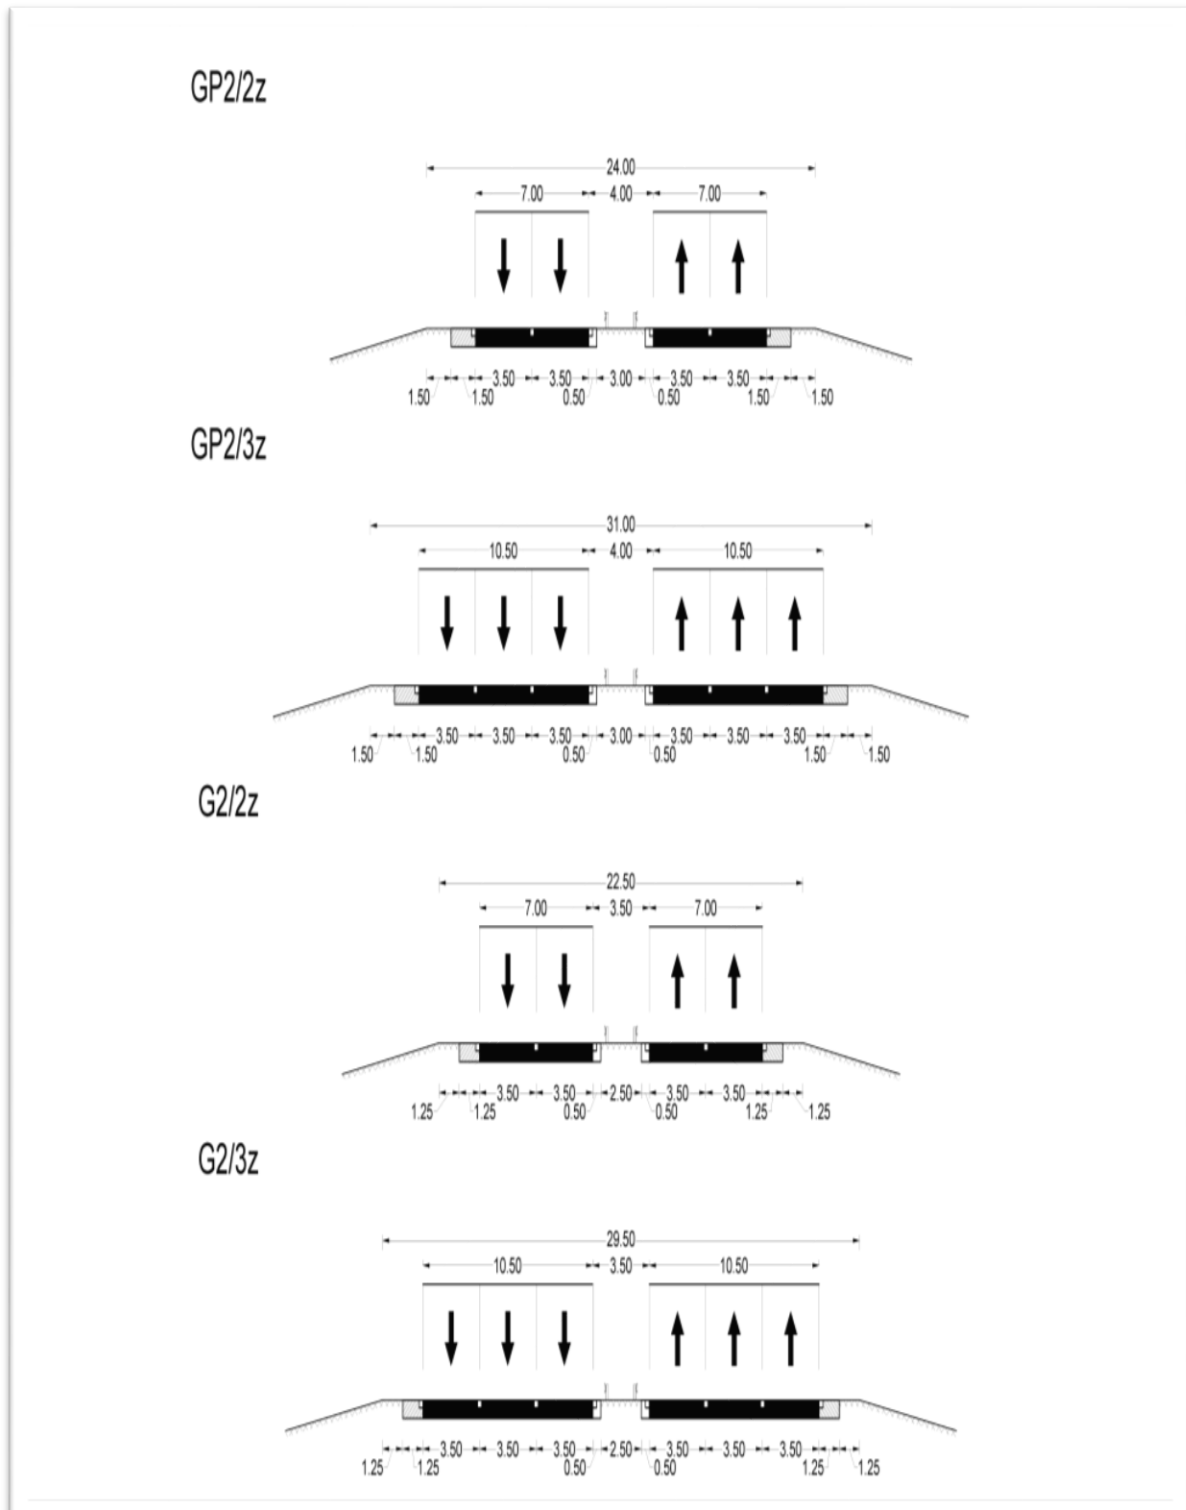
Schematy przyjętych do analiz typów przekroju poprzecznego autostrad.
